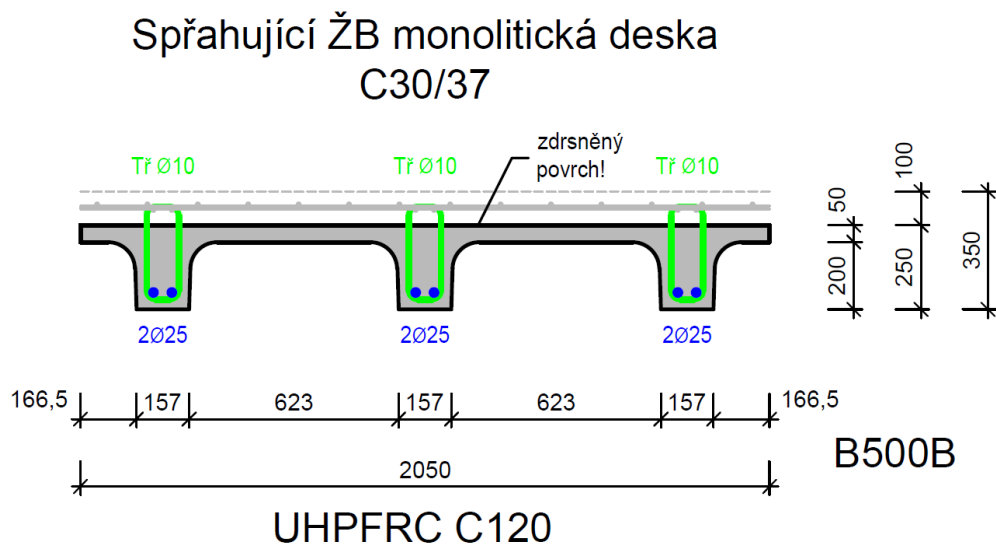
Příčný řez mostem Hradu Rychmburk – varianta rekonstrukce [6]
